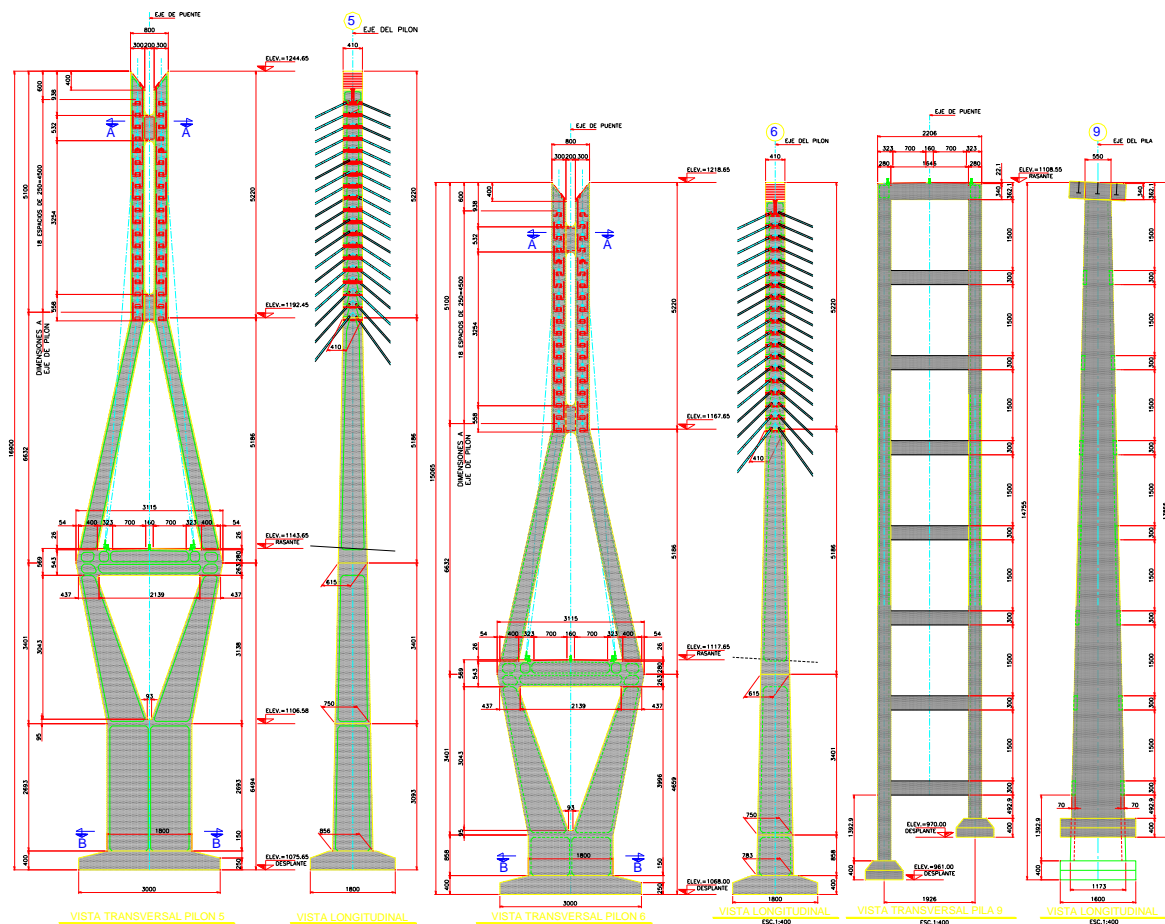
Apoyos 5,6 y 9 de la subestructura del puente Baluarte
